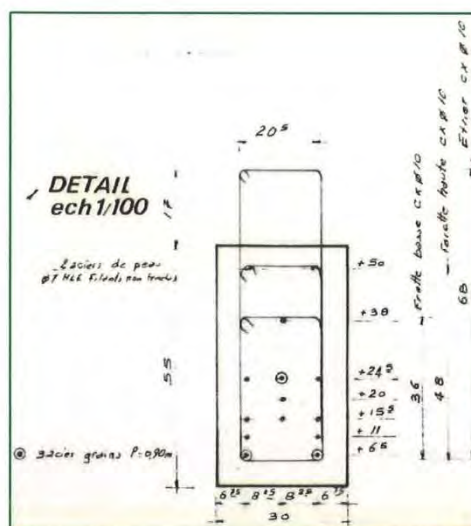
Coupe transversale sur poutre - Plan de ferrailage
